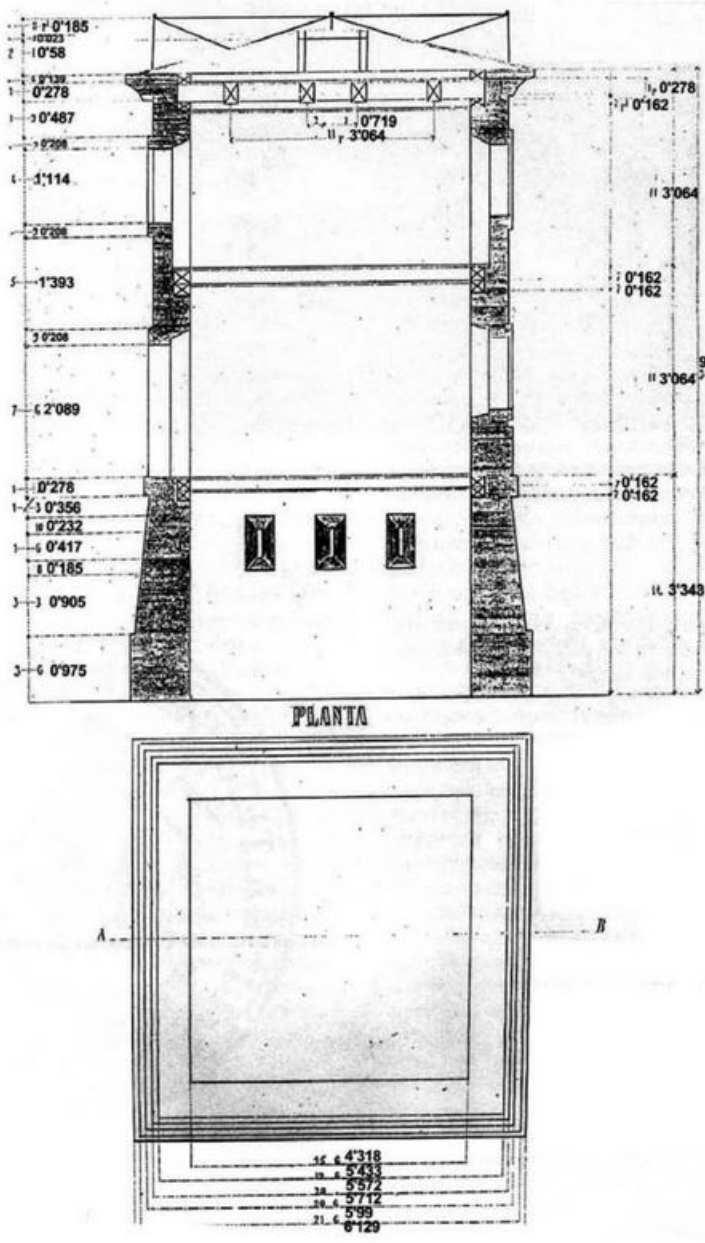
Planta y sección de una torre. Fuente: López Requena, 2008.
